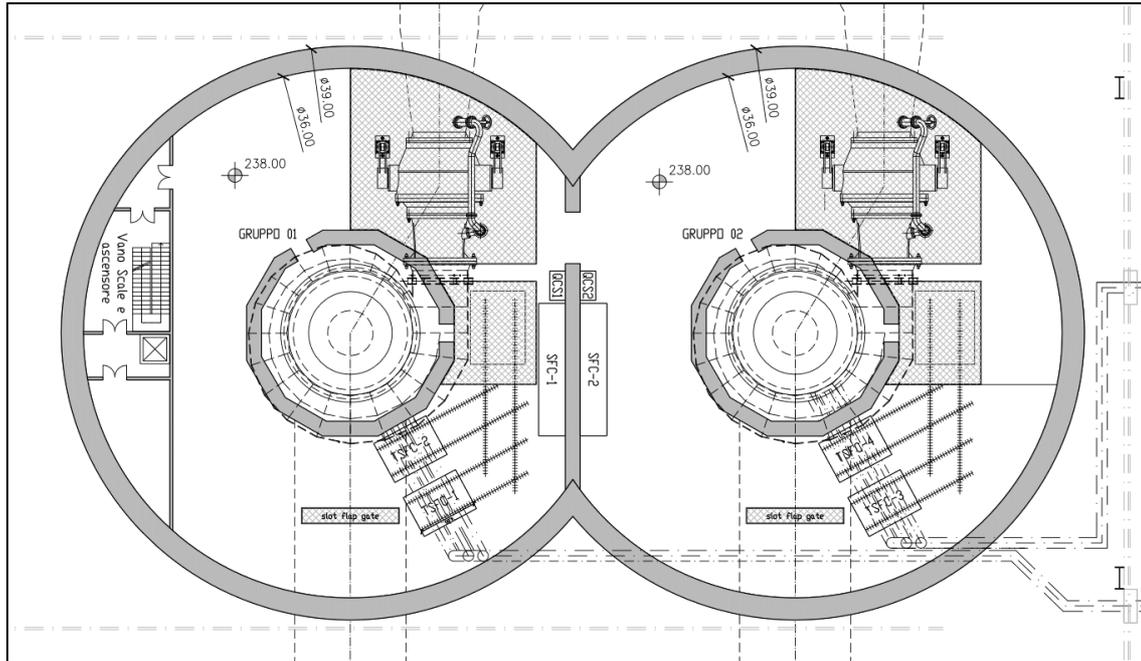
Pianta della centrale a quota 238.00 m s.l.m.
